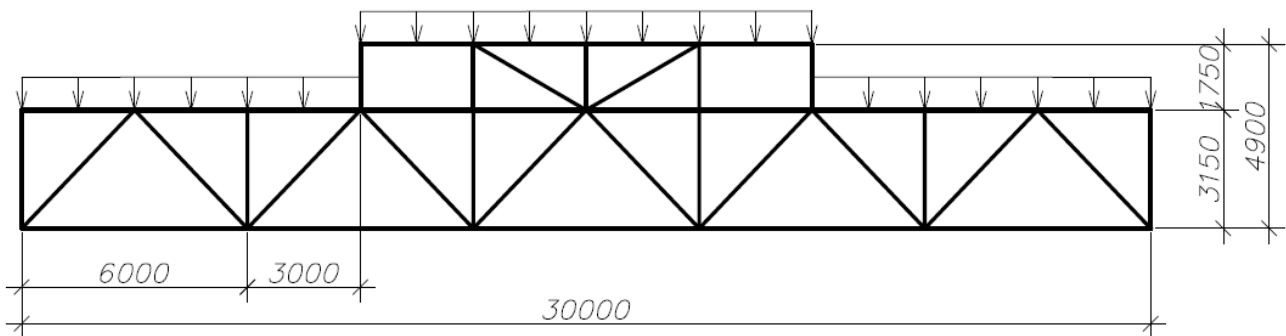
Конструктивна схема досліджуваної ферми і схемою базування навантаження
